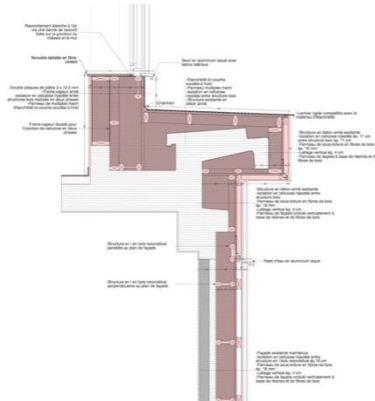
Détail en coupe de l'isolation de l'acrotère (AW Architectes, 2013)
